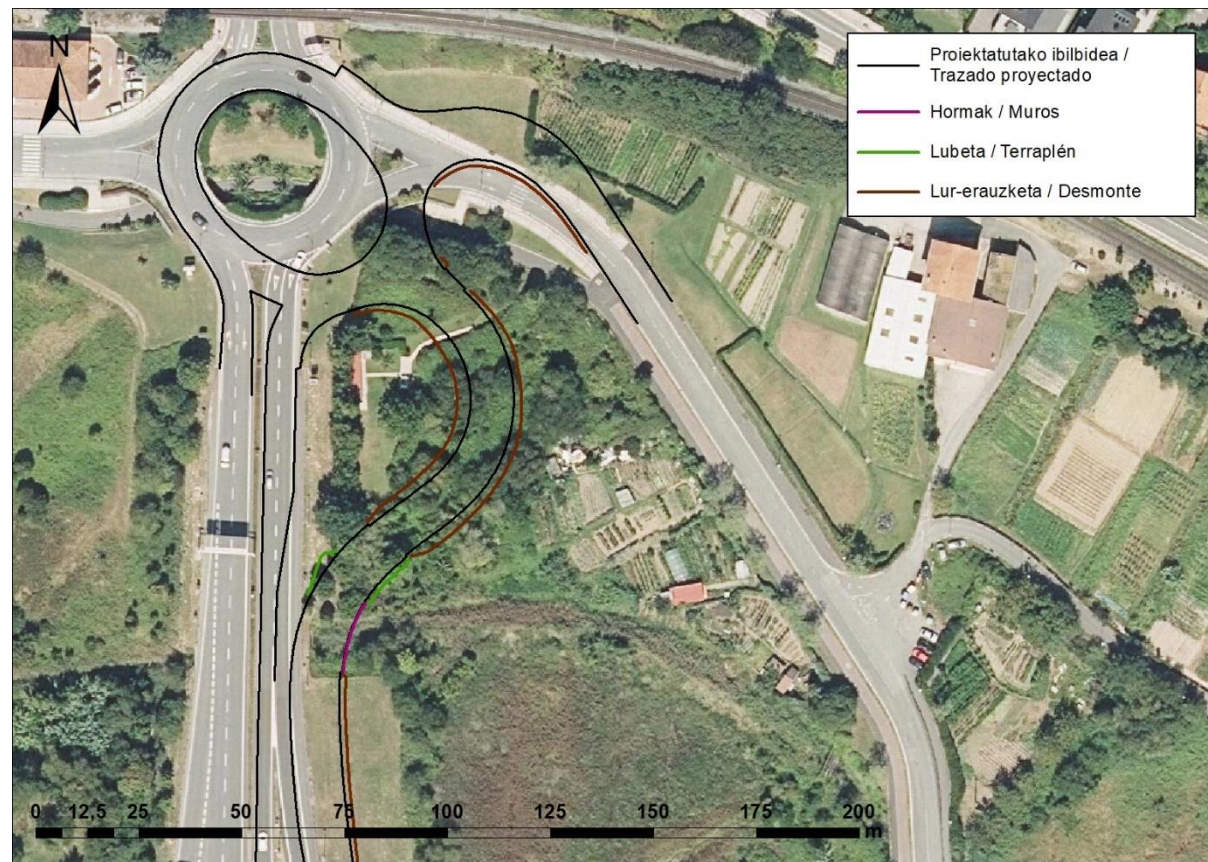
Tramo final proyectado entorno a la rotonda Asti-San Pelaio.
